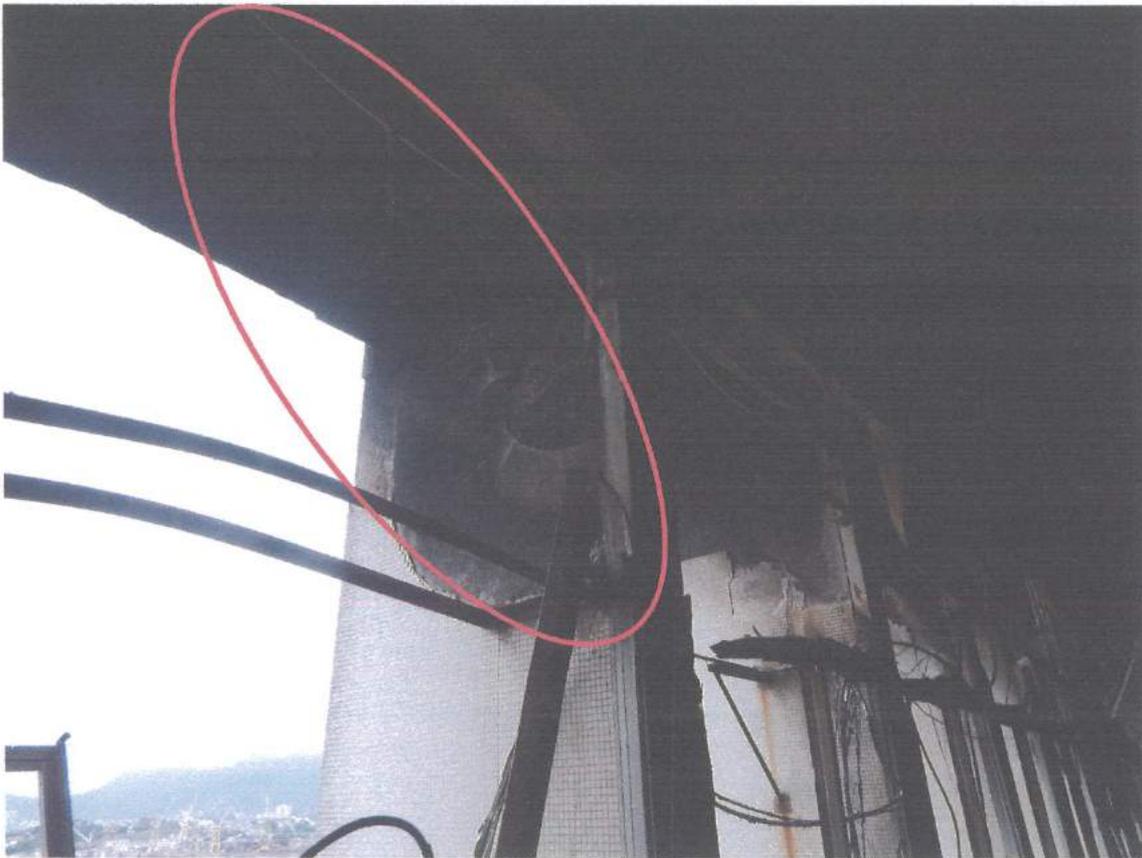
Intenso dano no pilar e no beiral da laje de teto
